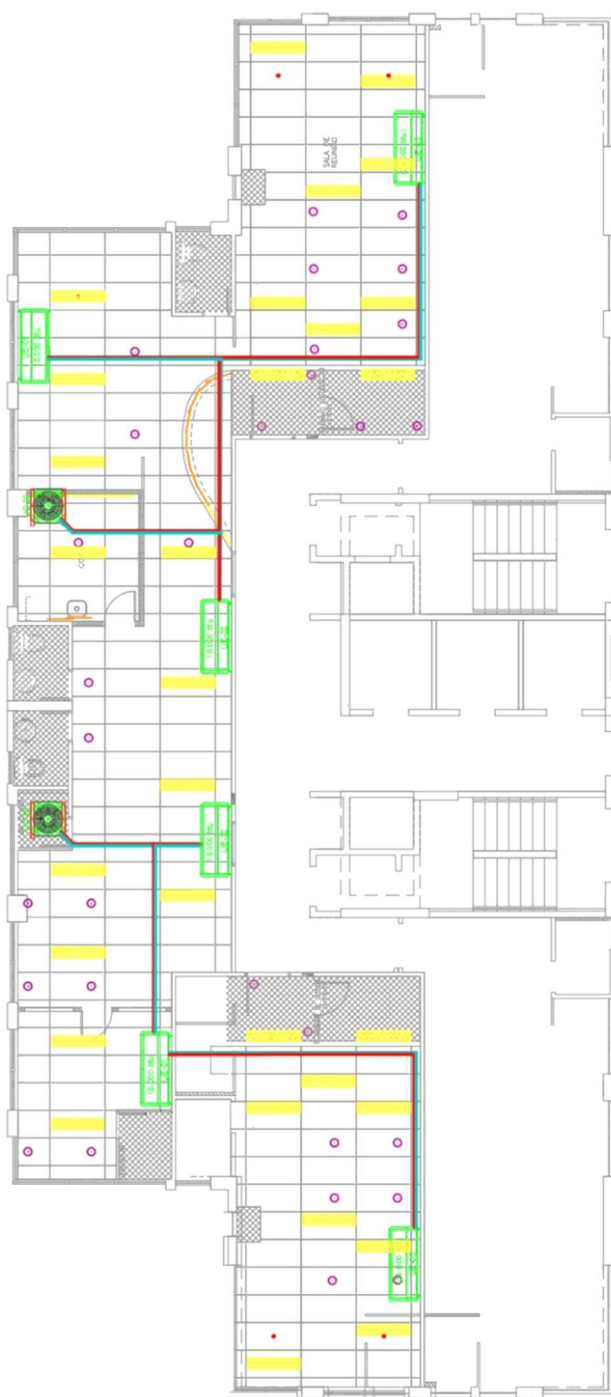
Layout Andar Tipo Projeto Proposto.
